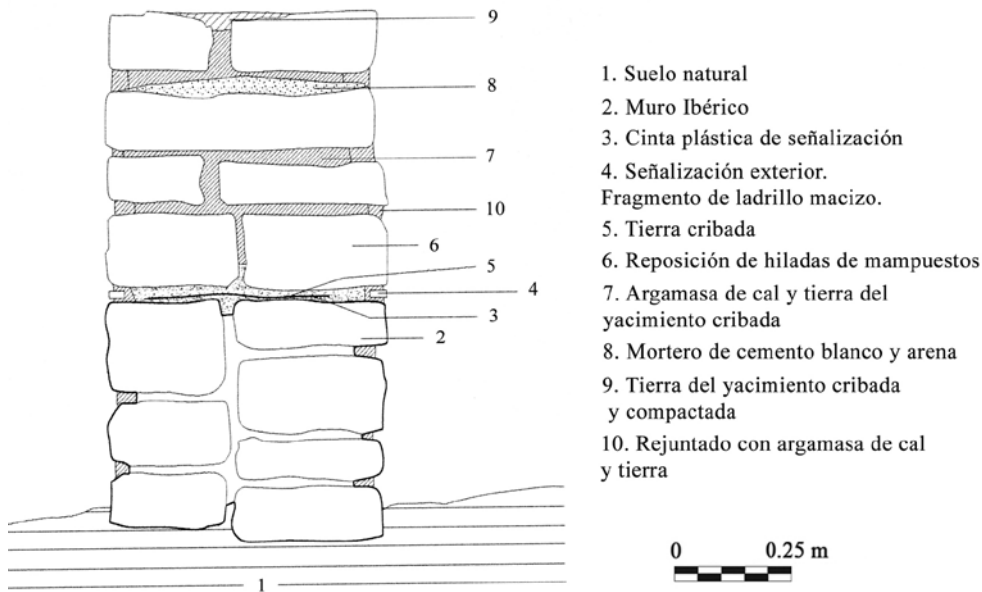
Sección de la actuación sobre los muros de mampostería.
